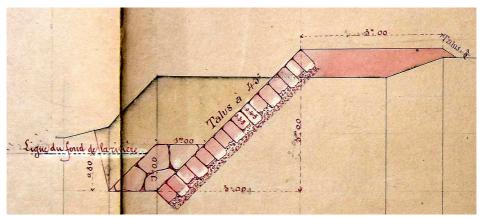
Profil en travers de la digue, v. 1881 (AD 73 – S 1267)
